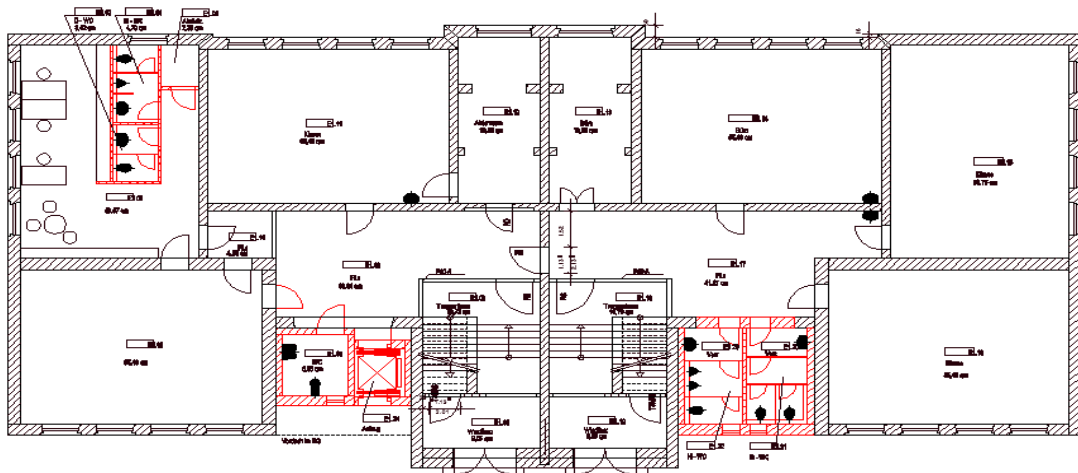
| Grundriss Erdgeschoss Georg-Löck Haus
